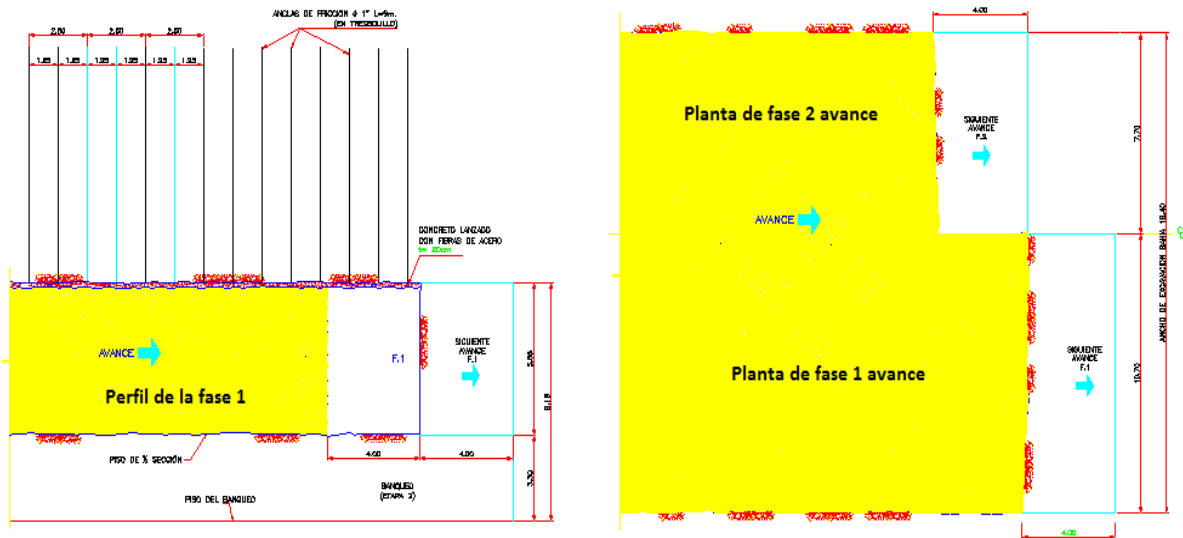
Perfil y planta del avance de la excavación en Condición Geotécnica B
